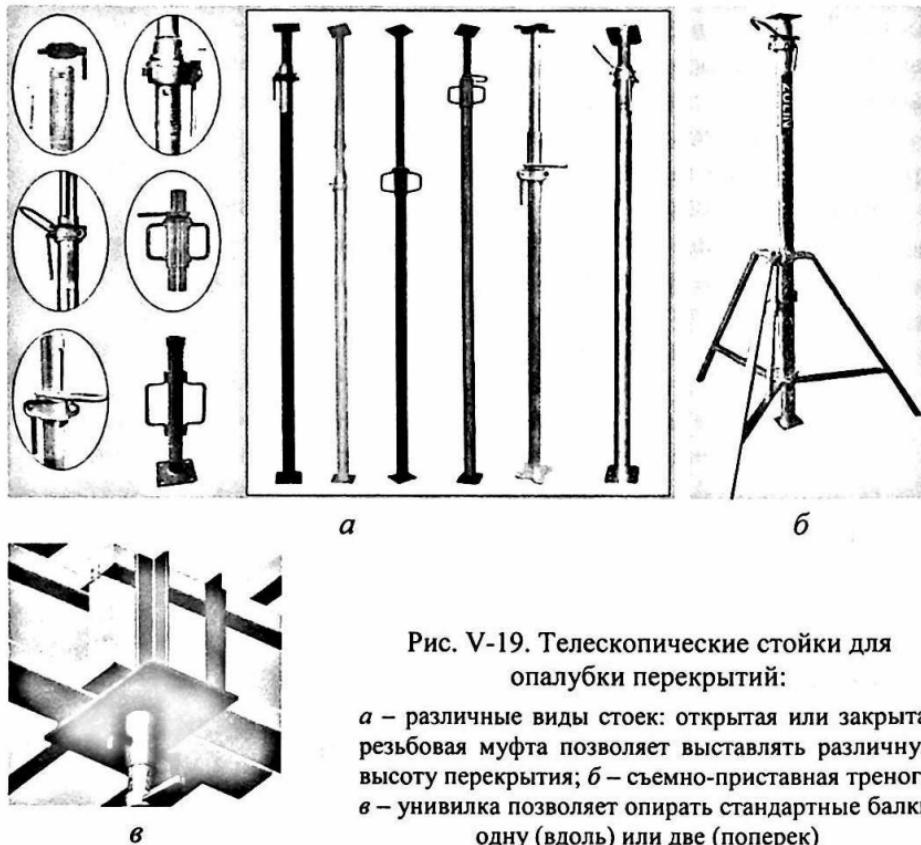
Телескопические стойки для опалубки перекрытий:
